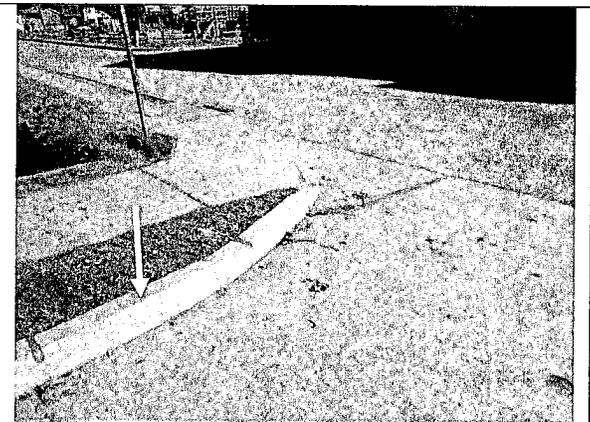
SOLERAS RECTAS Y SEPARACION > 5 MM
